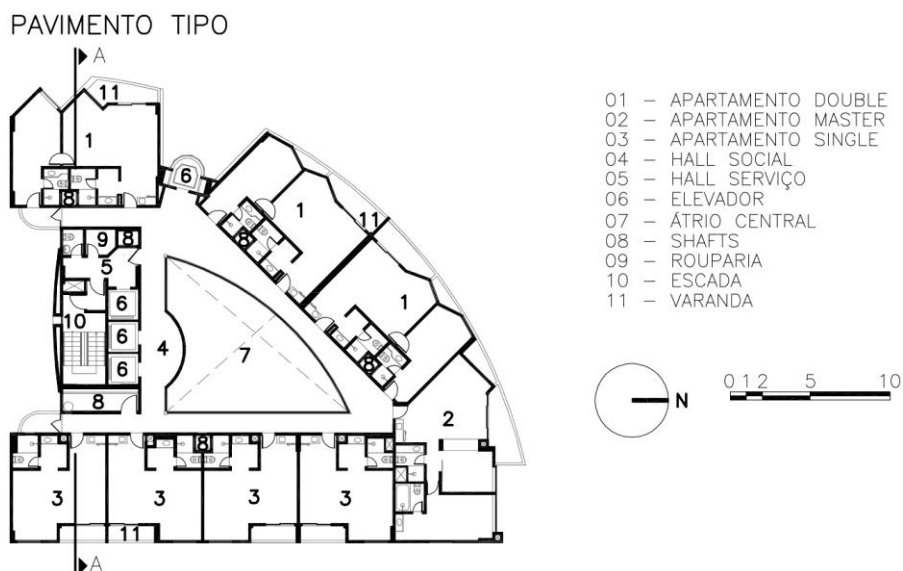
Othon Palace Fortaleza: 2º pavimento
